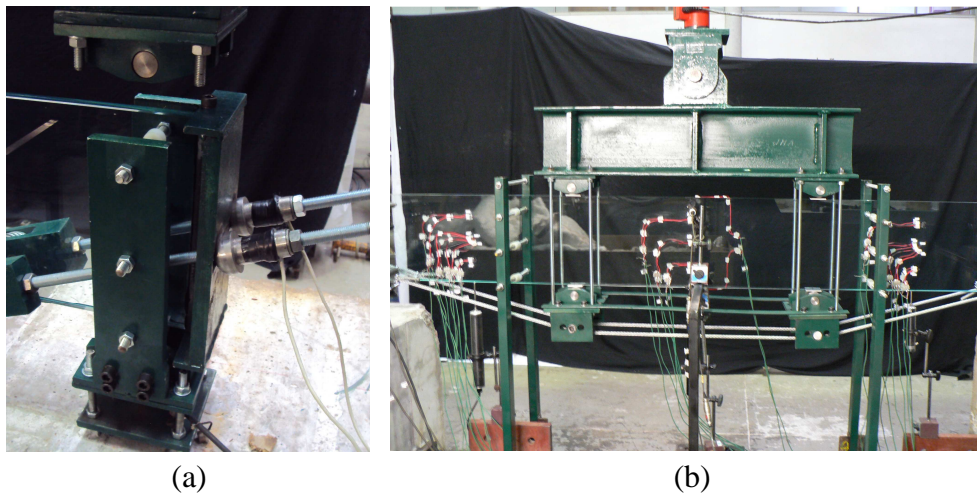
(a) Pormenor da zona de ancoragem do pré-esforço e (b) viga antes do ensaio.
